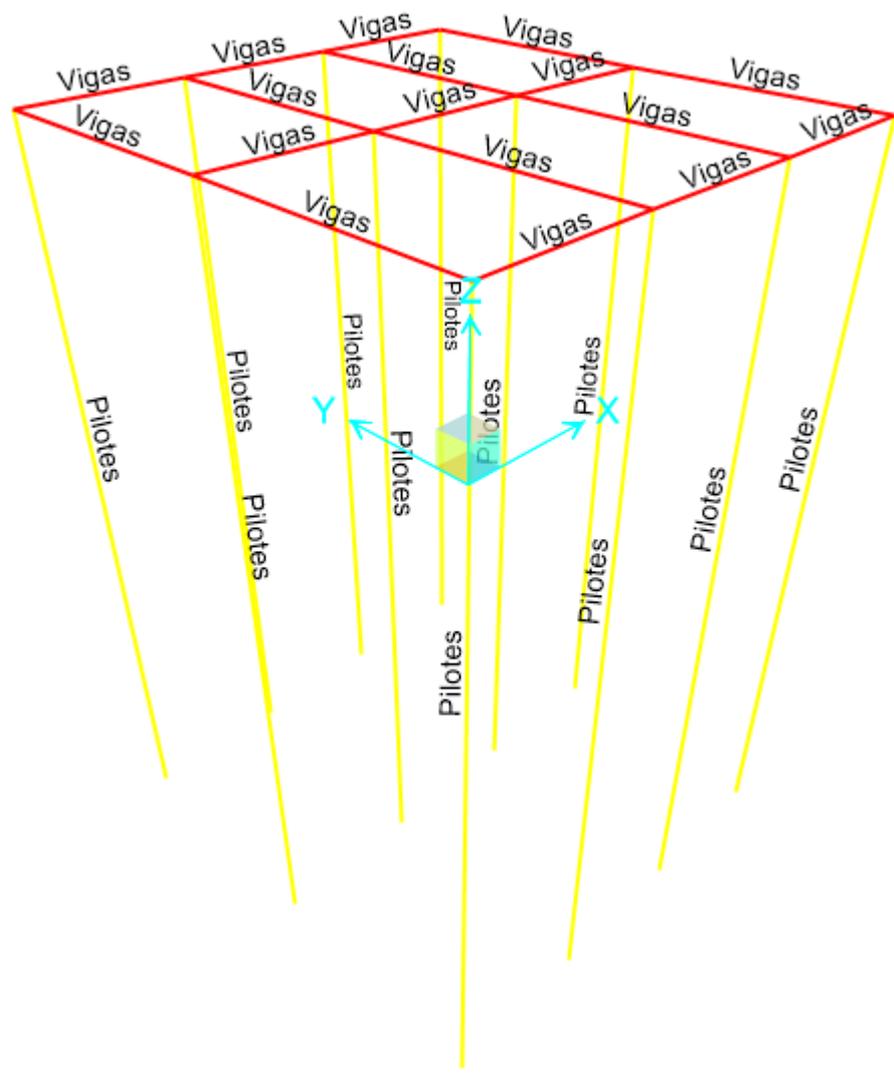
Modelo de cimentación profunda de vigas y pilotes. (SAP2000, 2017)
